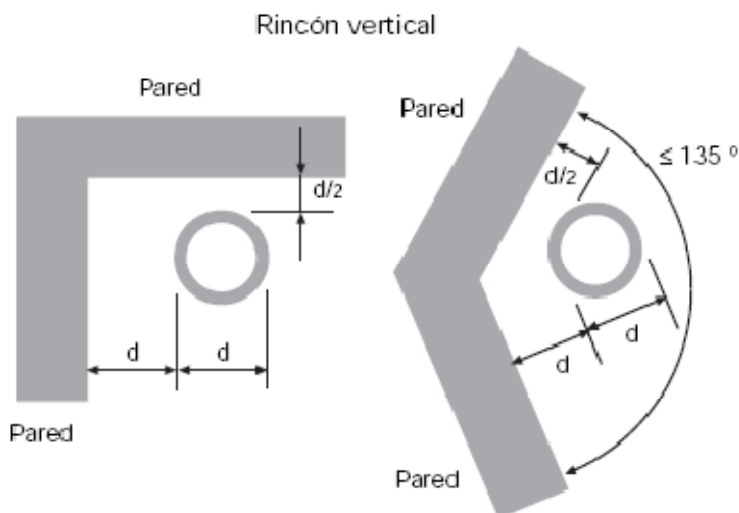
Distancia entre tubería de gas y rincón vertical.
